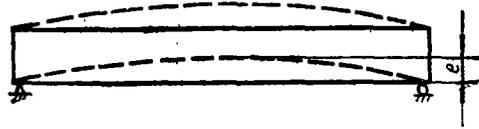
实线为钢筋混凝土梁，虚线为预应力混凝土梁
